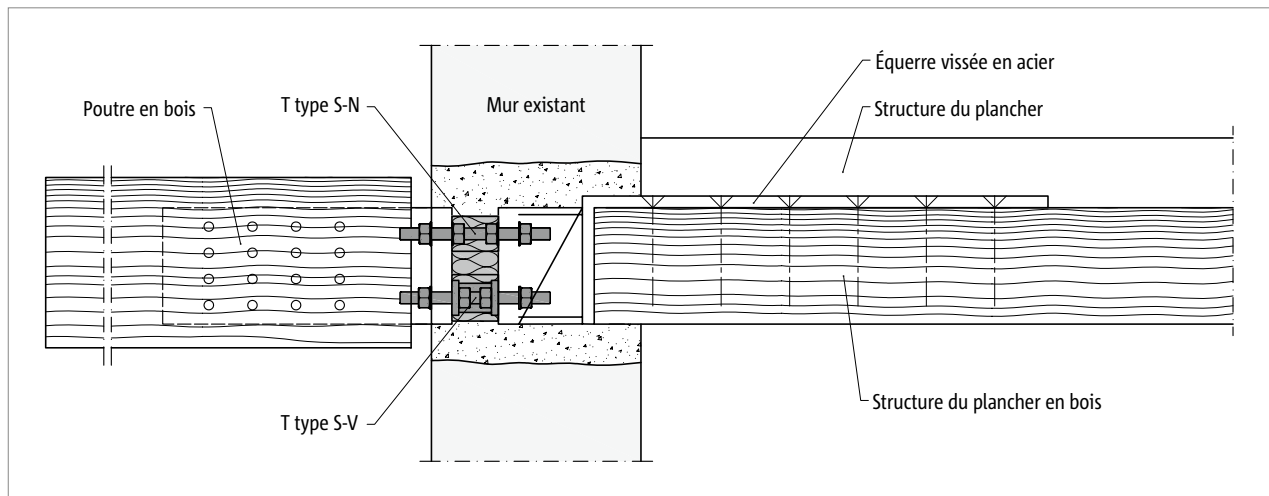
Schöck Isokorb® T type S-N et T type S-V : balcon en bois posé ultérieurement, en porte-à-faux ; raccordé à une structure existante de plancher en bois
